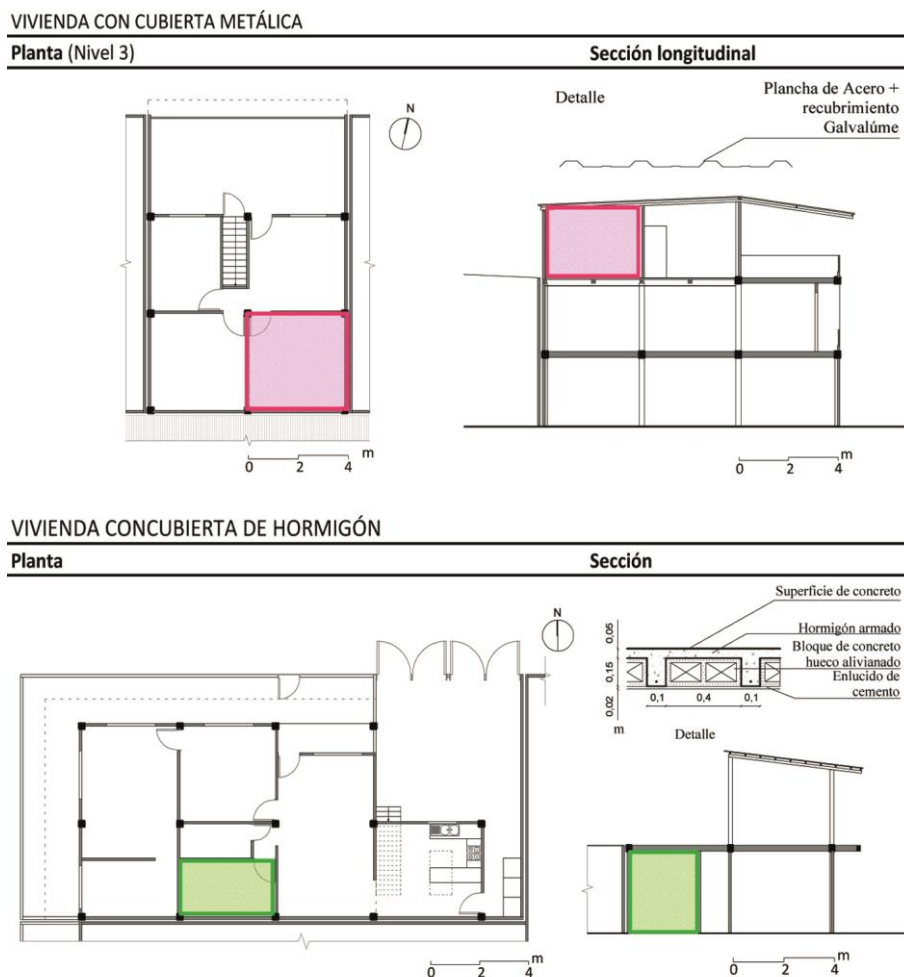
Planta y Sección de las dos viviendas usadas en el análisis experimental, y el detalle de las dos tipologías de cubiertas (hormigón y chapa metálica) de cada una de ellas.
